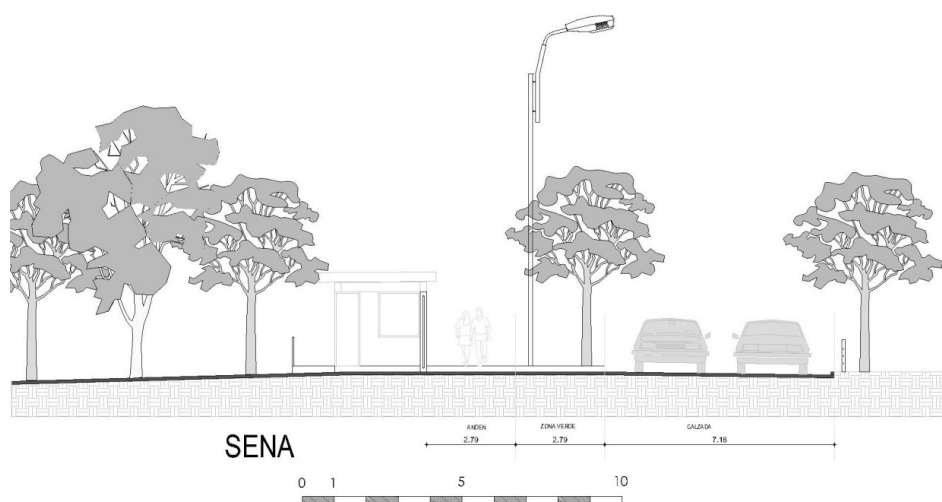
Perfil Vial calle perimetral del Sena- ingreso norte
